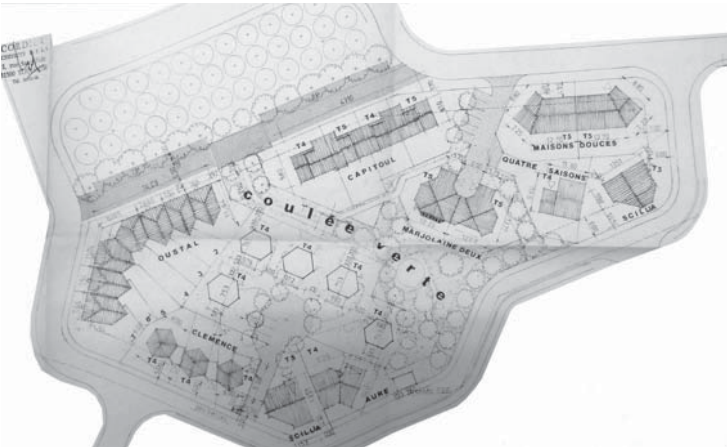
Plan de masse du village solaire, fond Cordier AMT, 1/2000
